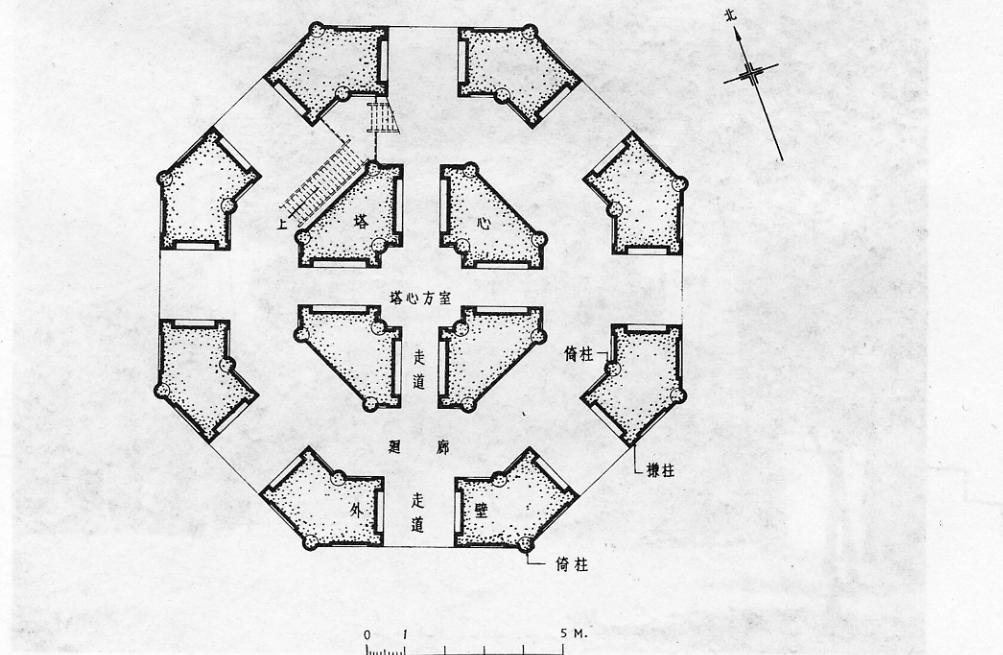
江苏苏州市虎丘山云岩寺塔平面图
